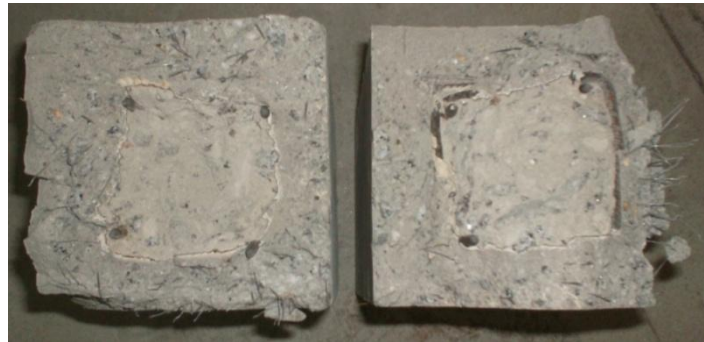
Secção transversal de um provete reforçado após realização do ensaio destrutivo
